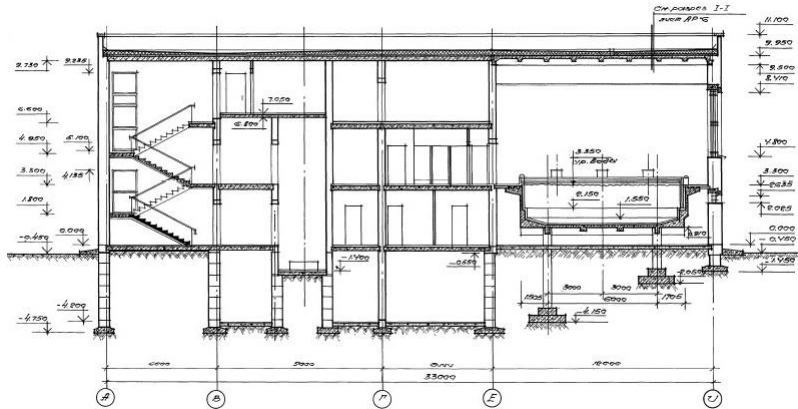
Разрез здания крытого бассейна, ТП 294-3-56.90
